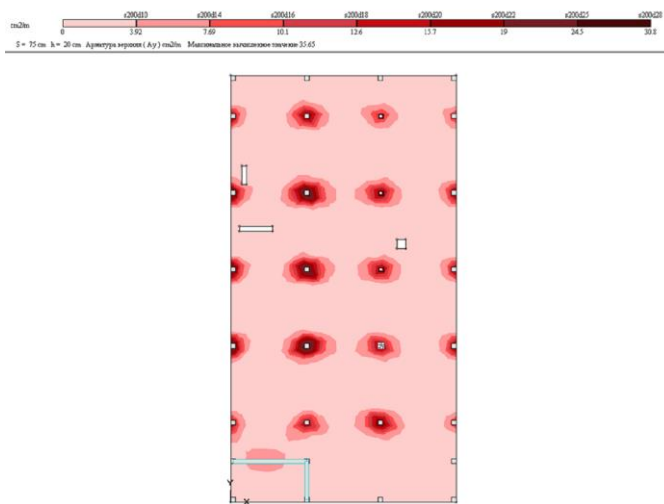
Армирование верхнего пояса по оси Y
